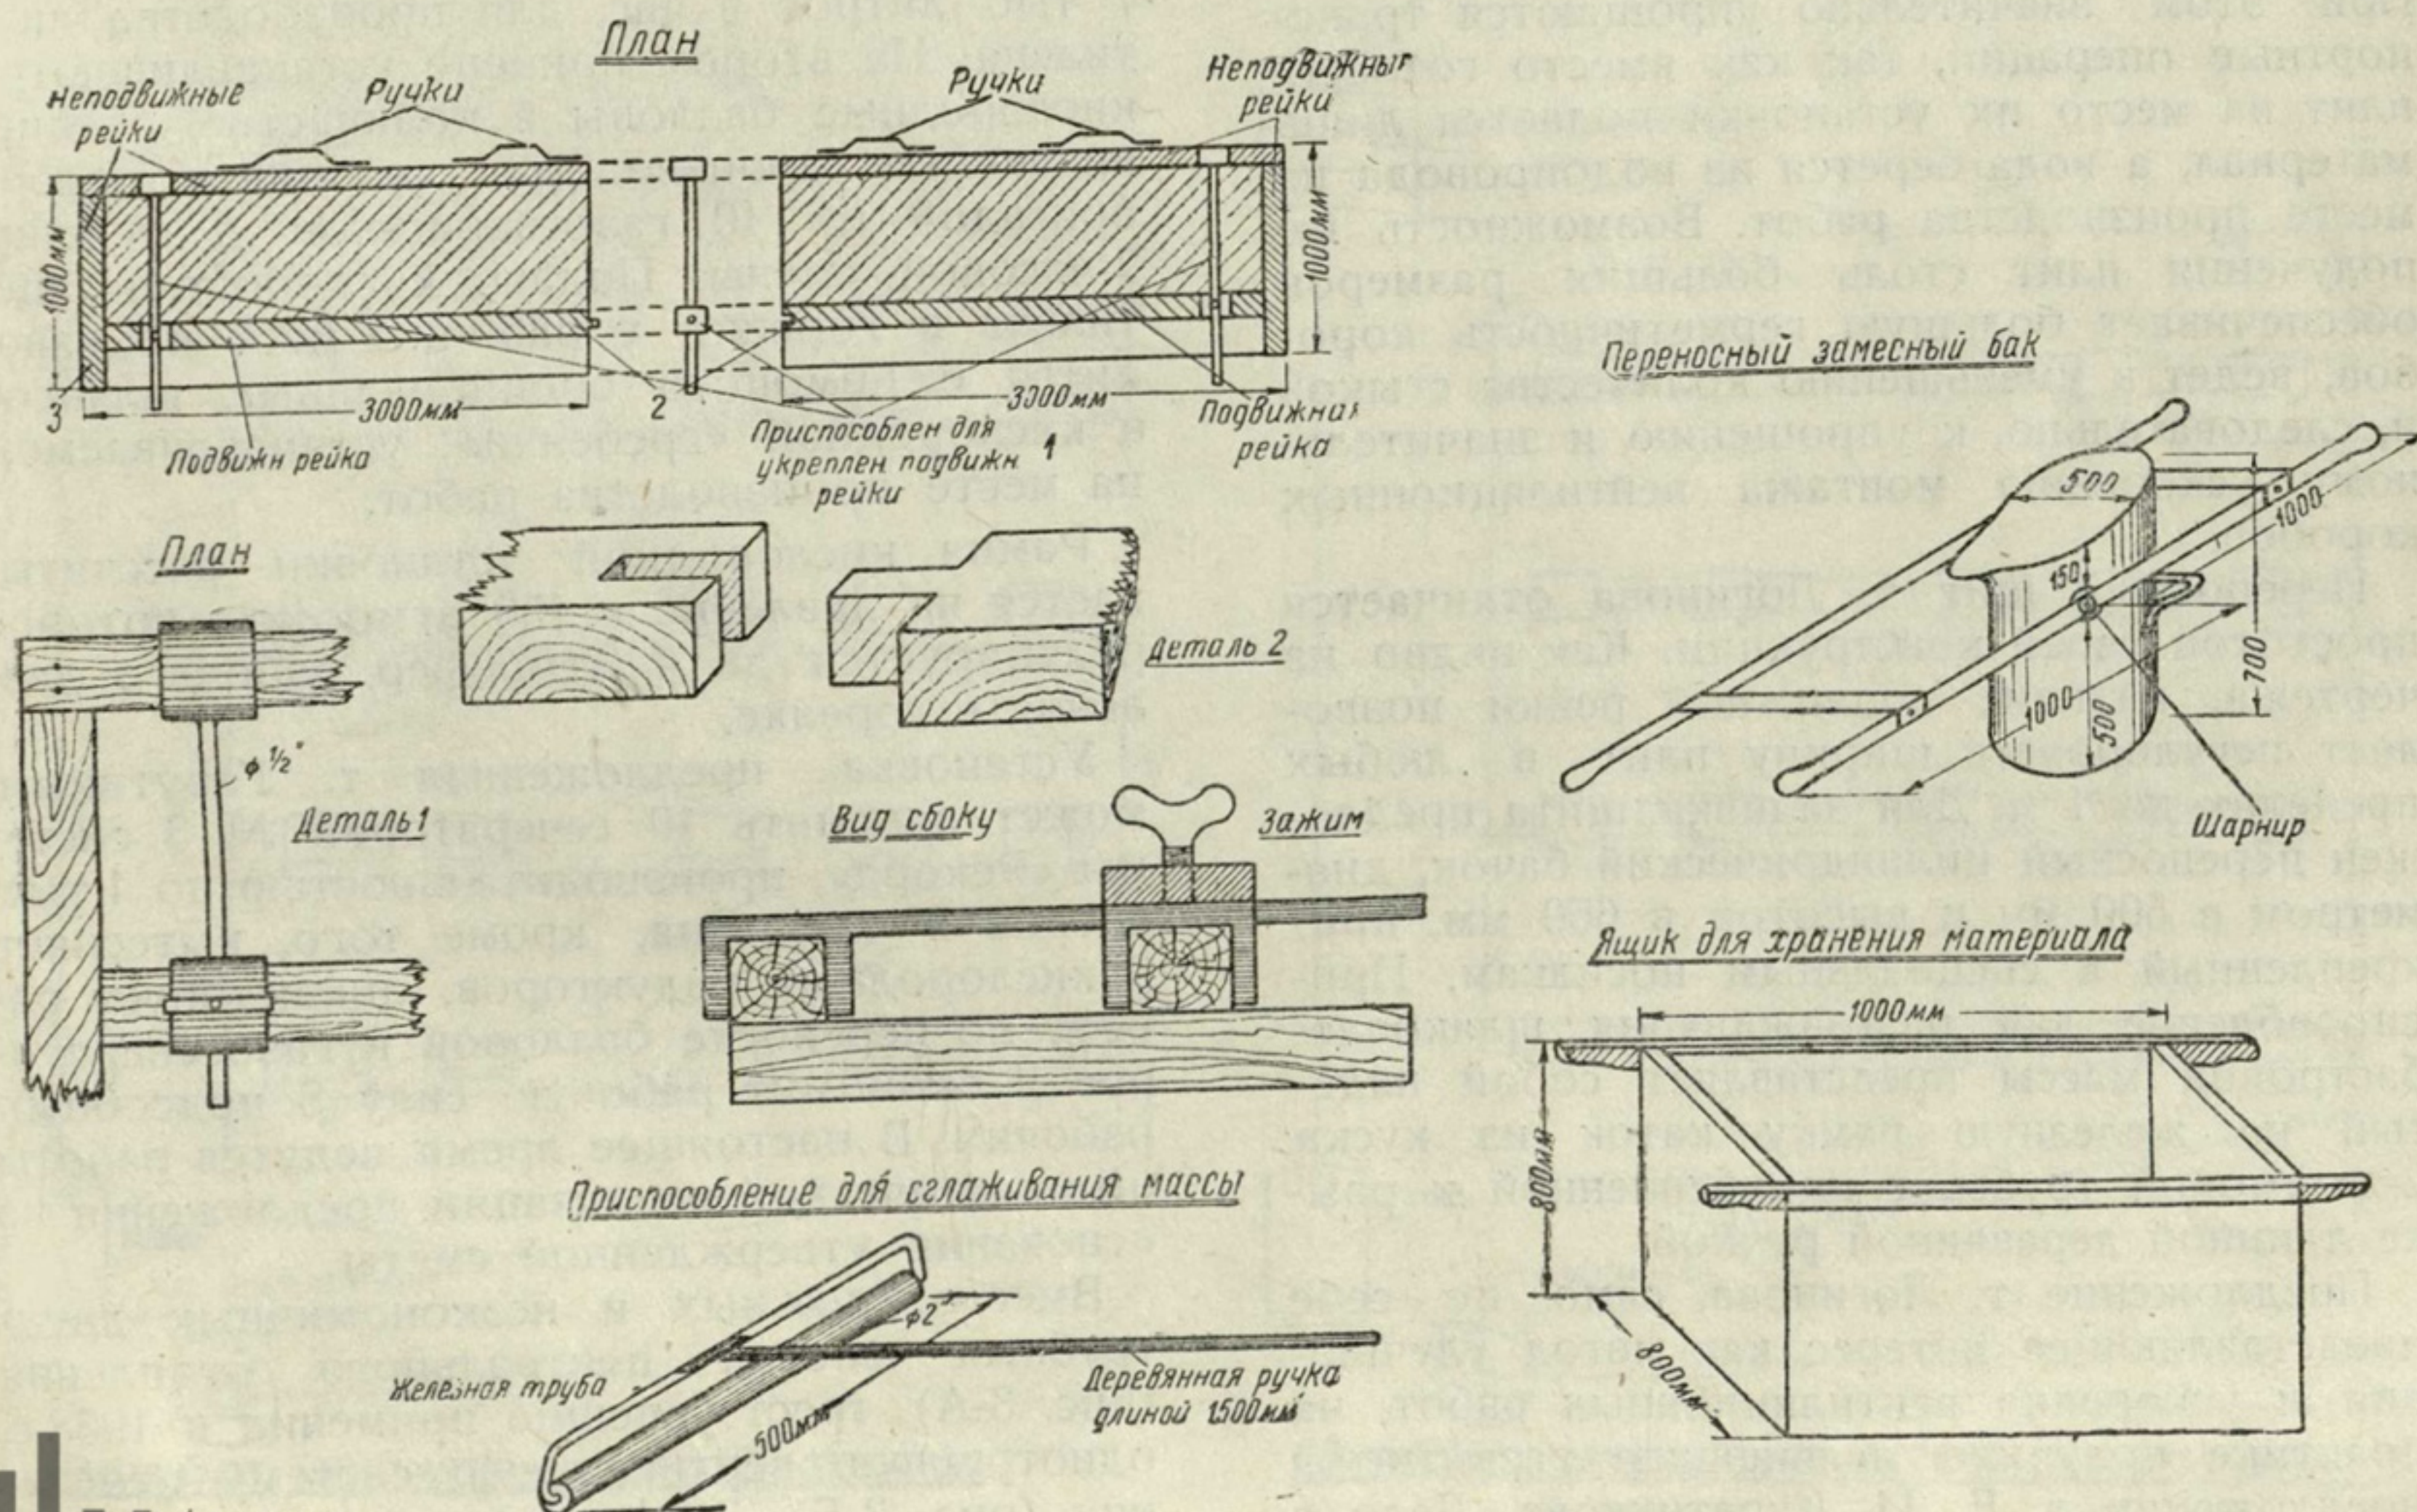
Переносный щит и приспособления для отливки шлакоалебастровых плит.
